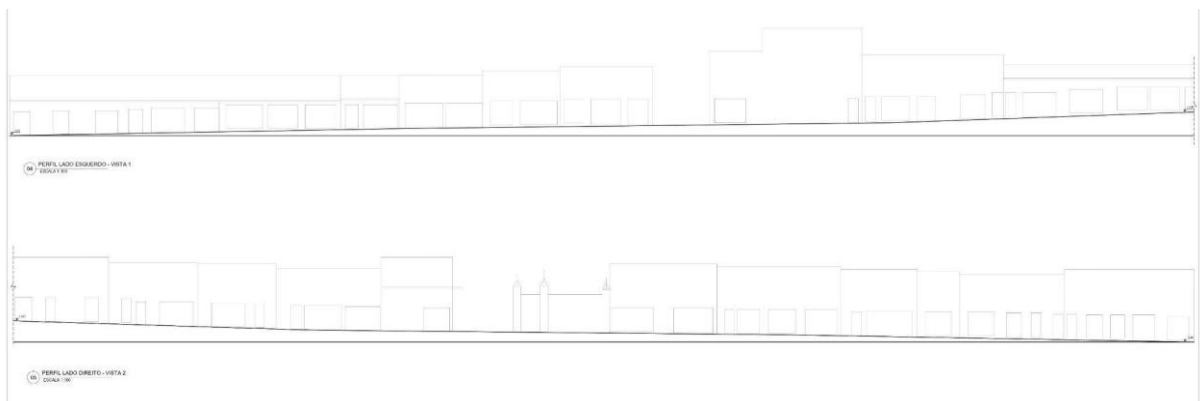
Vista direita e Vista Esquerda da Travessa Lopes Bahia - Proposta do novo perfil viário. Fonte: Os autores (2025)
